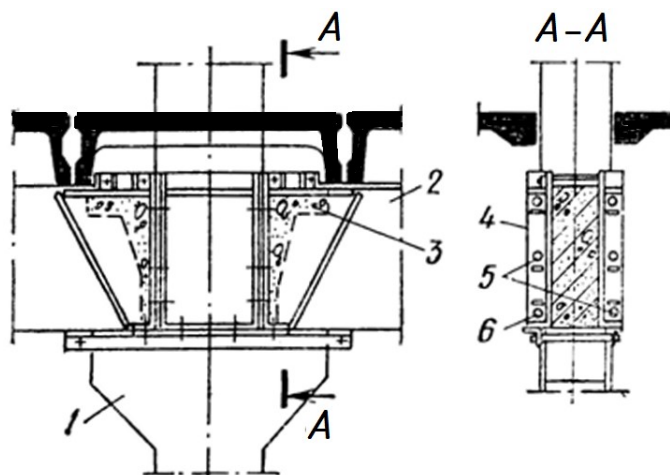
Інвентарна опалубка для замонолічування ригелів прямокутного перерізу з середньою колоною: 1 – колона; 2 – ригель; 3 – бетон закладання; 4 – щити опалубки; 5 – отвори для кріплення відбивачів з джерелами інфрачервоних променів; 6 – болти
